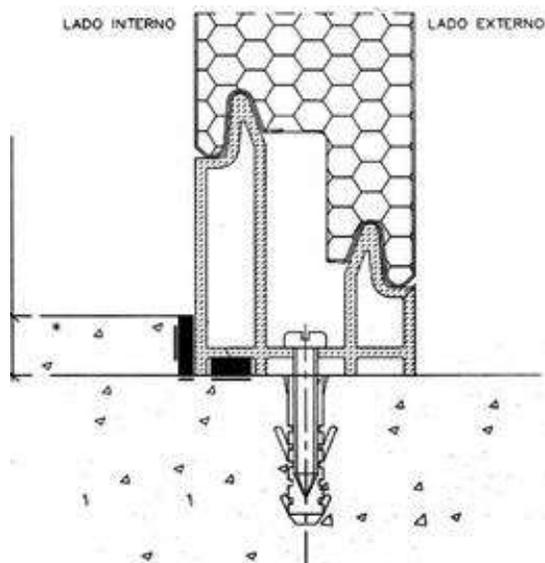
Detalhe de projeto do elemento da subestrutura de apoio posicionado no piso e sua fixação. (DÂNICA, 2013a)
